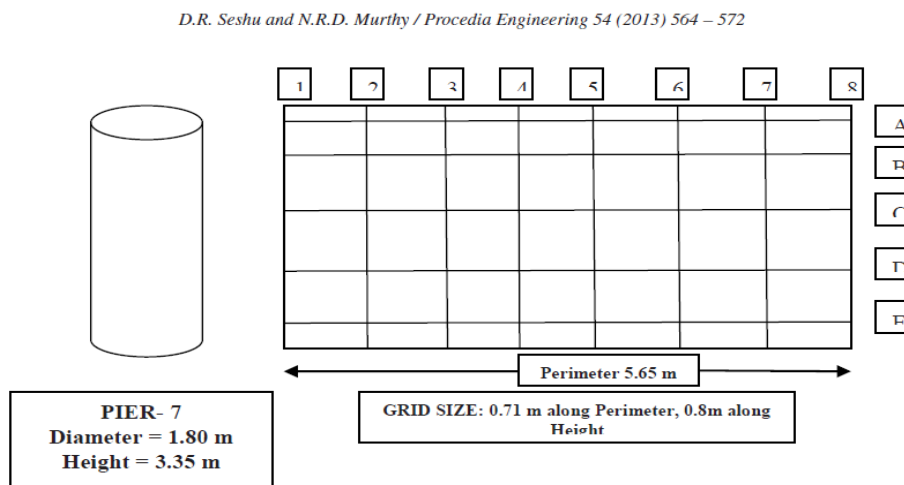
Pruebas de Puente Pier usando martillo de rebote
